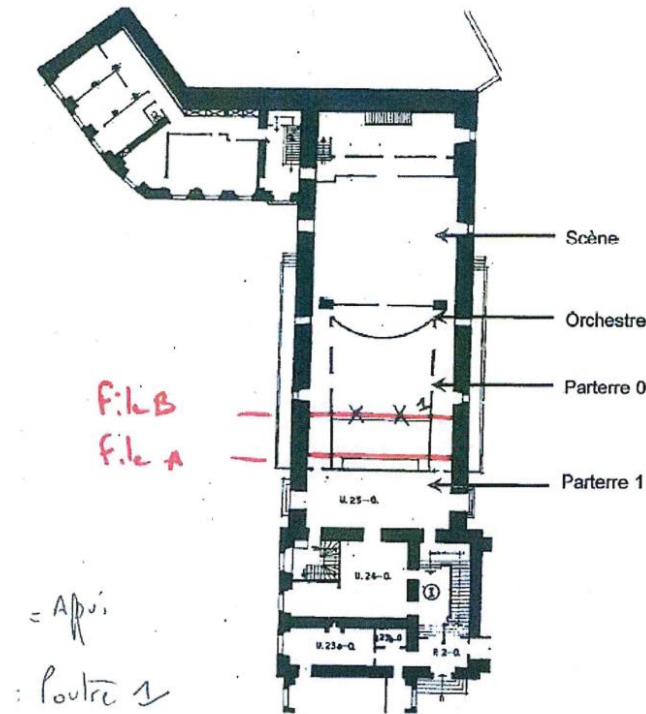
Plan de localisation - Extrait note Bureau Veritas
